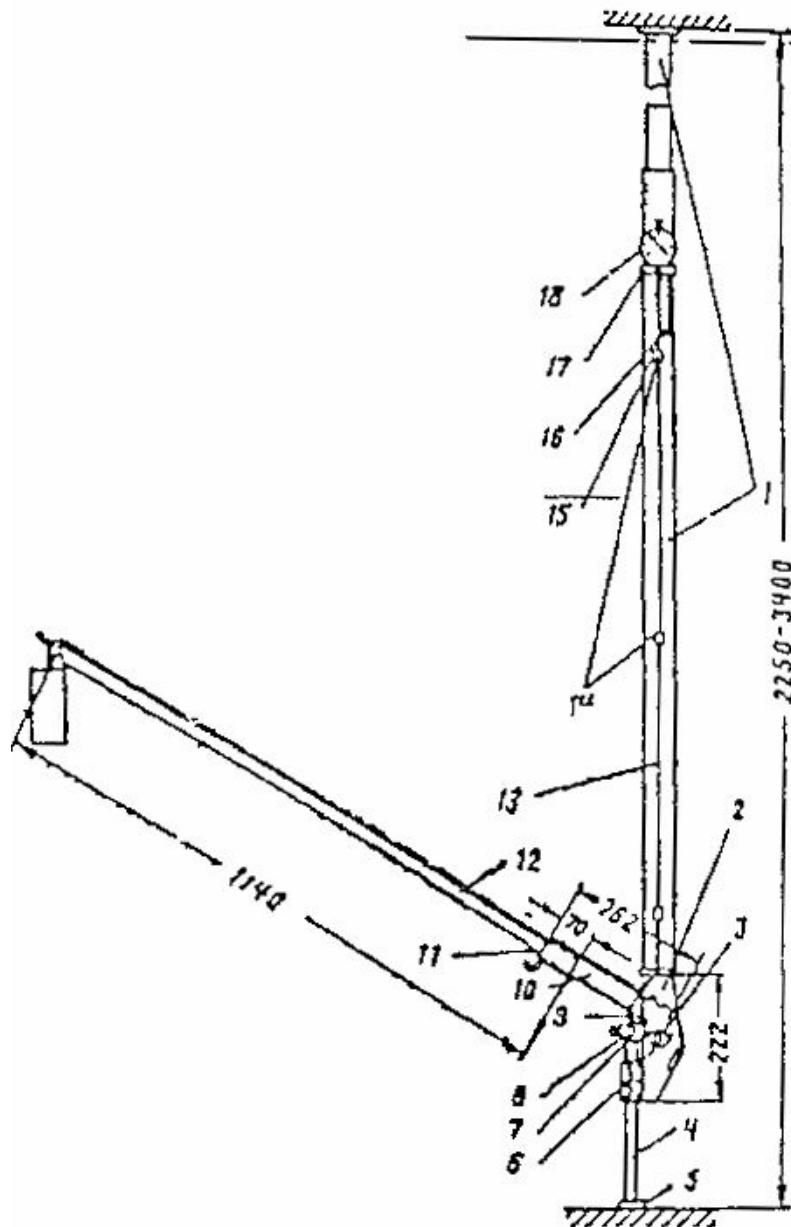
Схема прибора для испытания полов под нагрузкой
